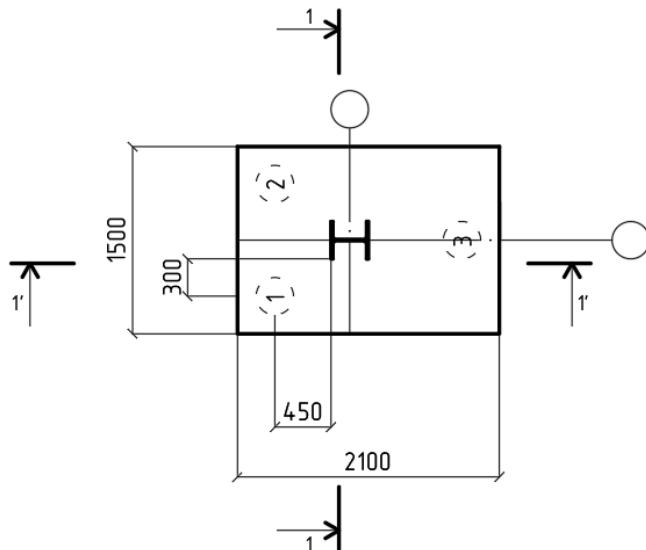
Схема к расчету ростверка на изгиб
